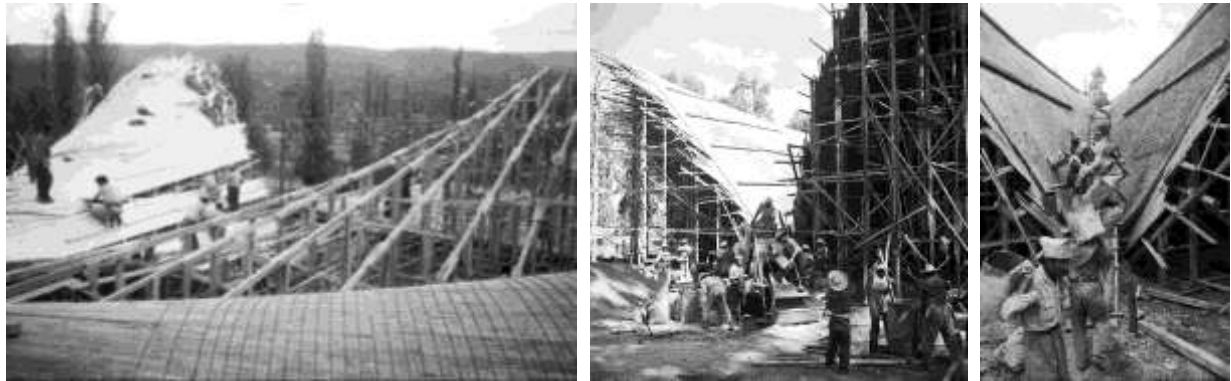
Proceso constructivo del restaurante Los Manantiales en Xochimilco, donde se aprecia la construcción del encofrado y el “boteado” del hormigón. Fotos: Juan Guzmán, 1958 (ATM)
